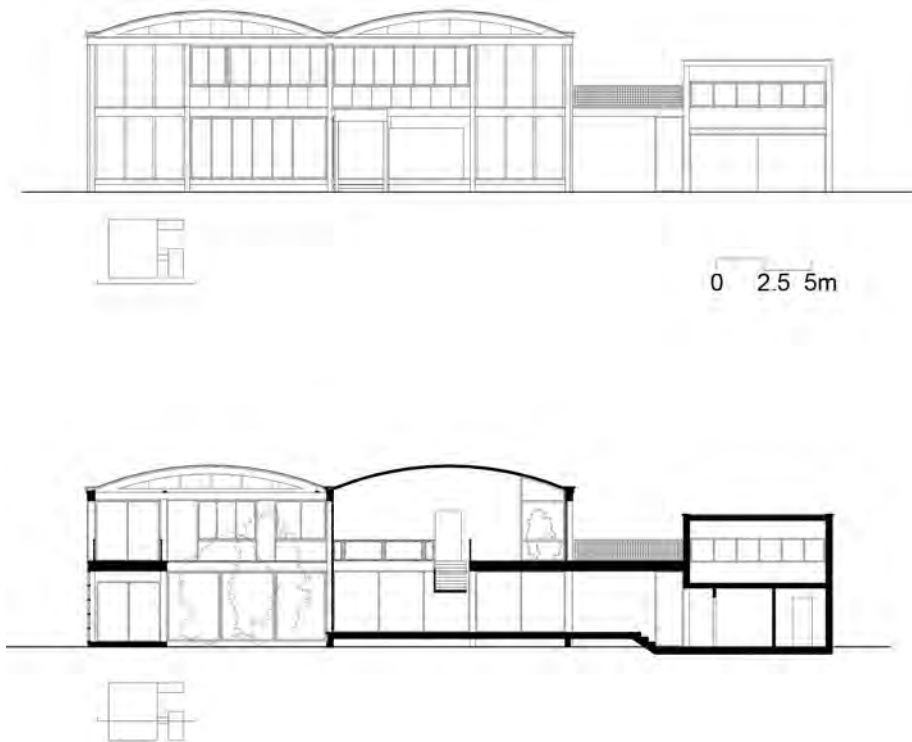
Casa Shaio, prospetto nord e sezione. Fonte: elaborazione dell'autrice.
